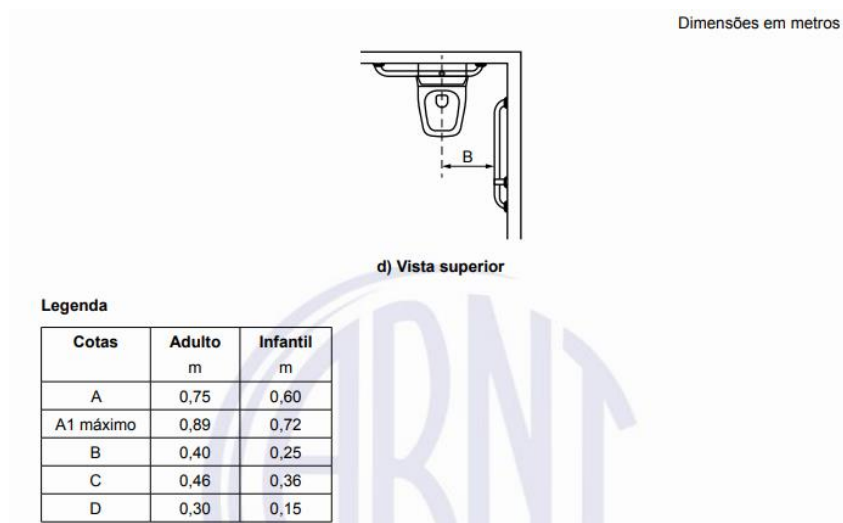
Vista superior das barras de apoio (ABNT, 2020)
